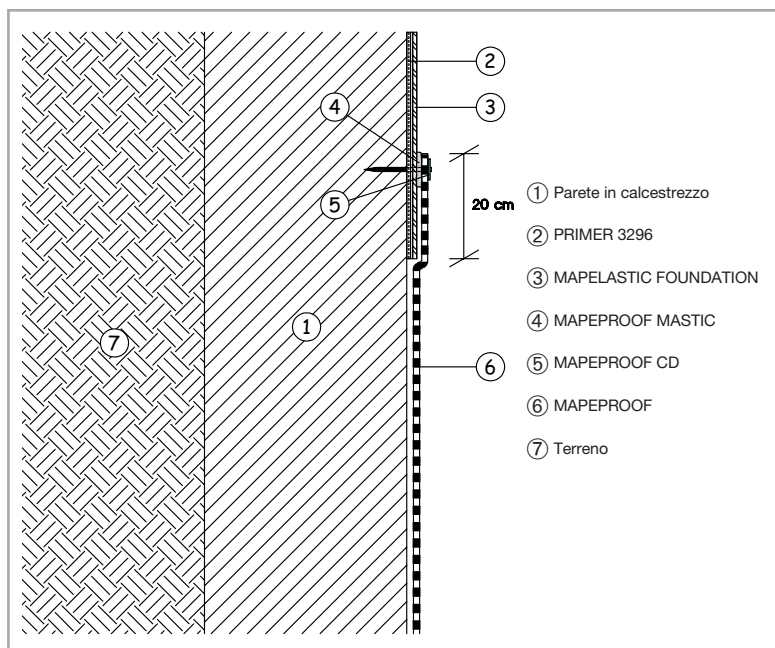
Raccordo MAPELASTIC FOUNDATION e MAPEPROOF per impermeabilizzazione in post-getto di pareti verticali
